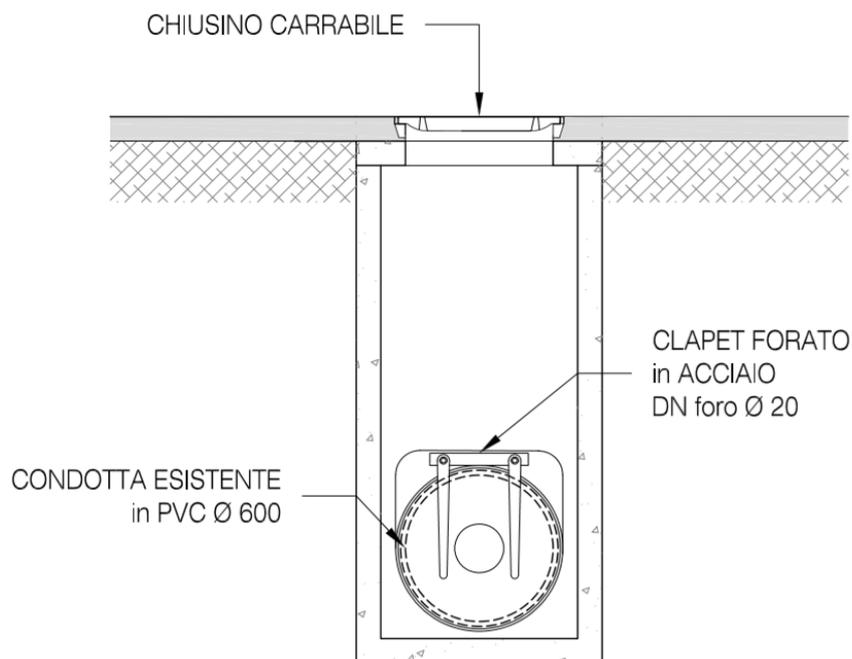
Individuazione planimetrica e dettaglio di progetto del manufatto di controllo.
